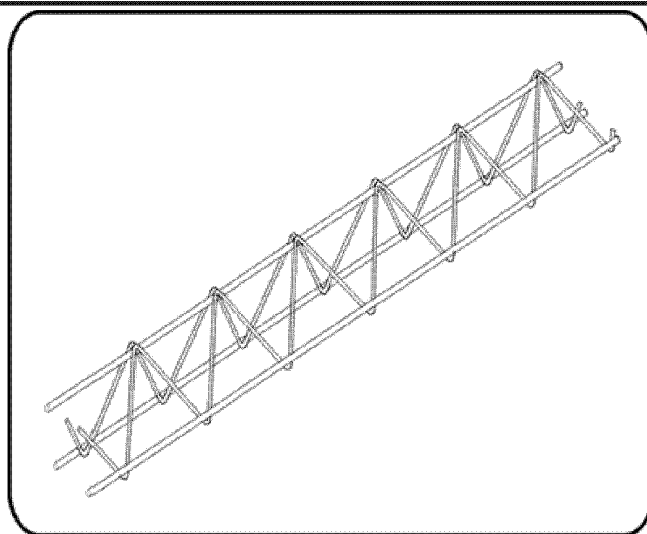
Modelo de treliça utilizada nas lajes [3].
